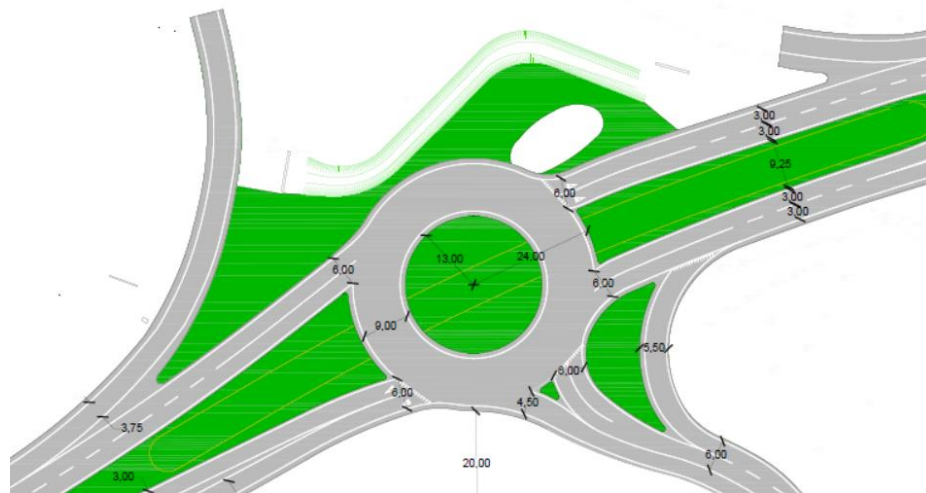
Rotatoria lungo via San Marco – Ipotesi 1 – Planimetria di progetto
